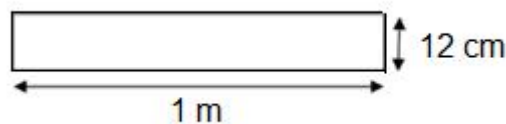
Coupe transversale d'une bande de la dalle.
